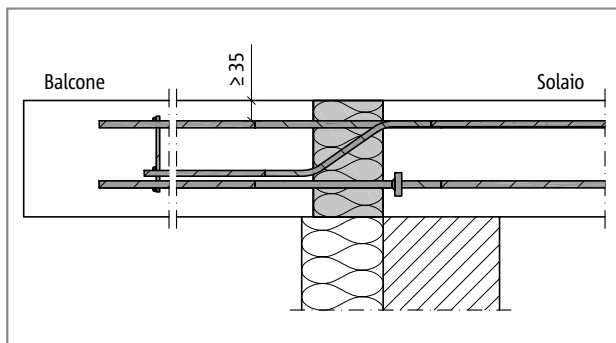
Schöck Isokorb® tipo EXT-CV35: raccordo con sistema di isolamento a cappotto (WDVS)
